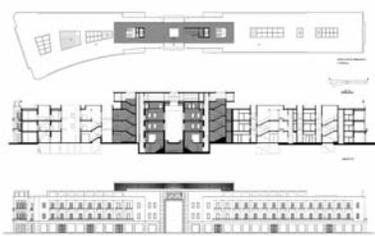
Prospetto principale, sezione longitudinale, pianta della copertura dell'ipotesi progettuale
